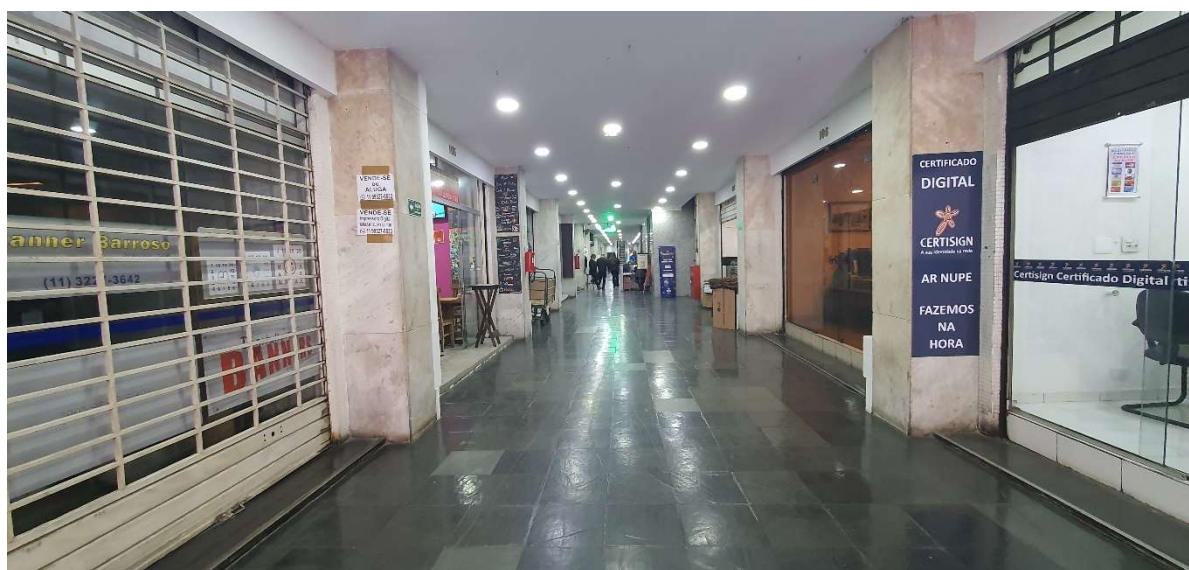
VISTA DO HALL NO TÉRREO A PARTIR DA ENTRADA.
